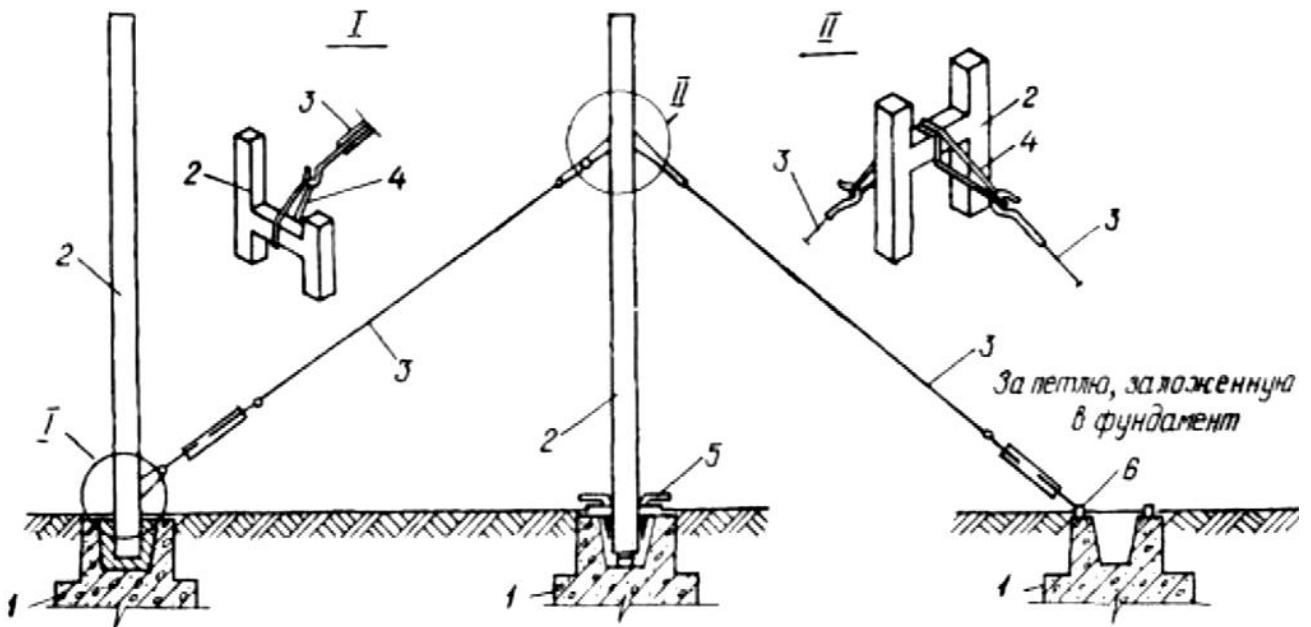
Схемы временного крепления расчалками колонн длиной более 12 м: 1 - фундаменты; 2 - колонны; 3 - расчалки с винтовой стяжкой; 4 - стропы; 5 - клиновые вкладыши; 6 - петля
